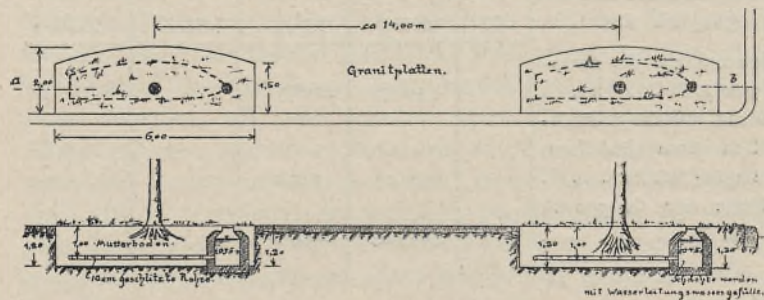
u. 14. Unterirdische Bewässerung von Baumanlagen, Nähe Zentralpark, New-York. Schnitt und Grundriß.
